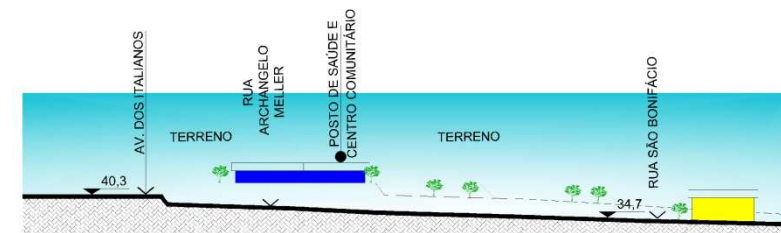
Corte Esquemático 01 – Rua Nova Erechim
